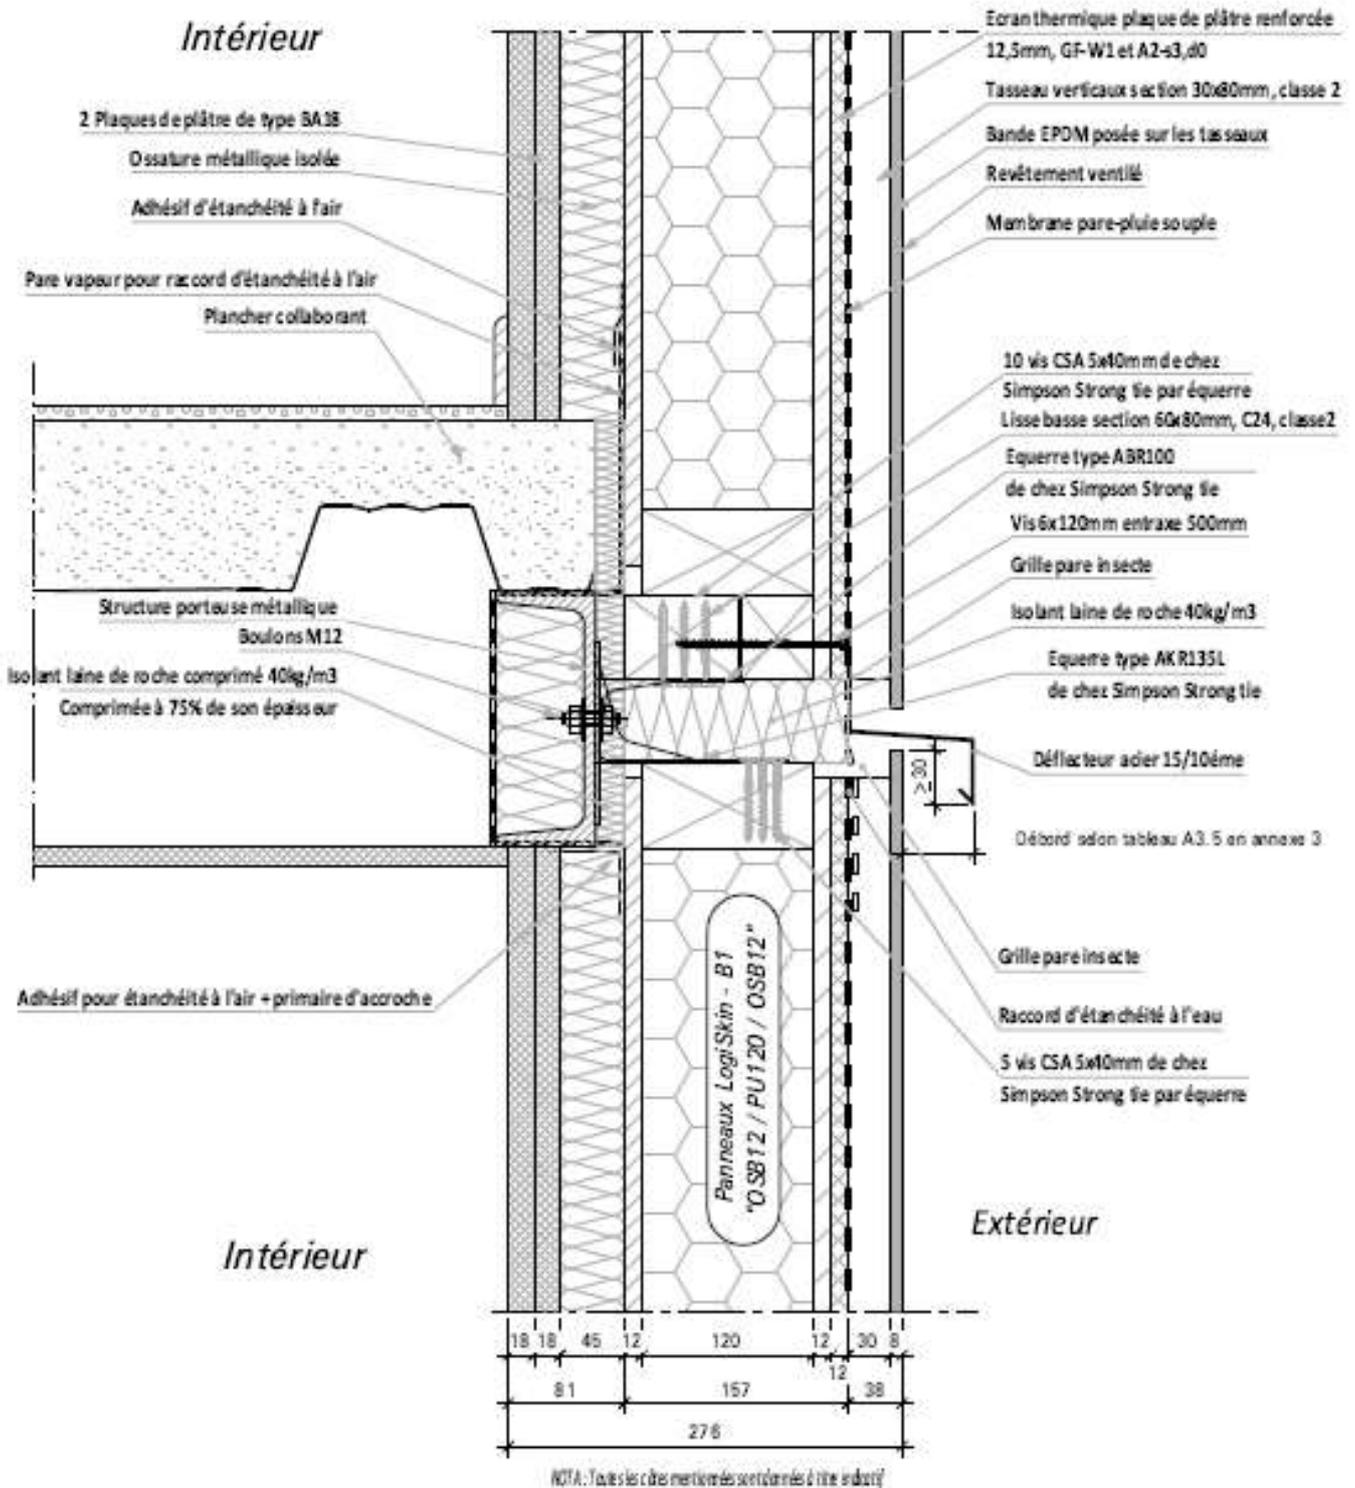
Détail CV-2.4 – jonction avec plancher acier/béton (mode de pose 2.1)
